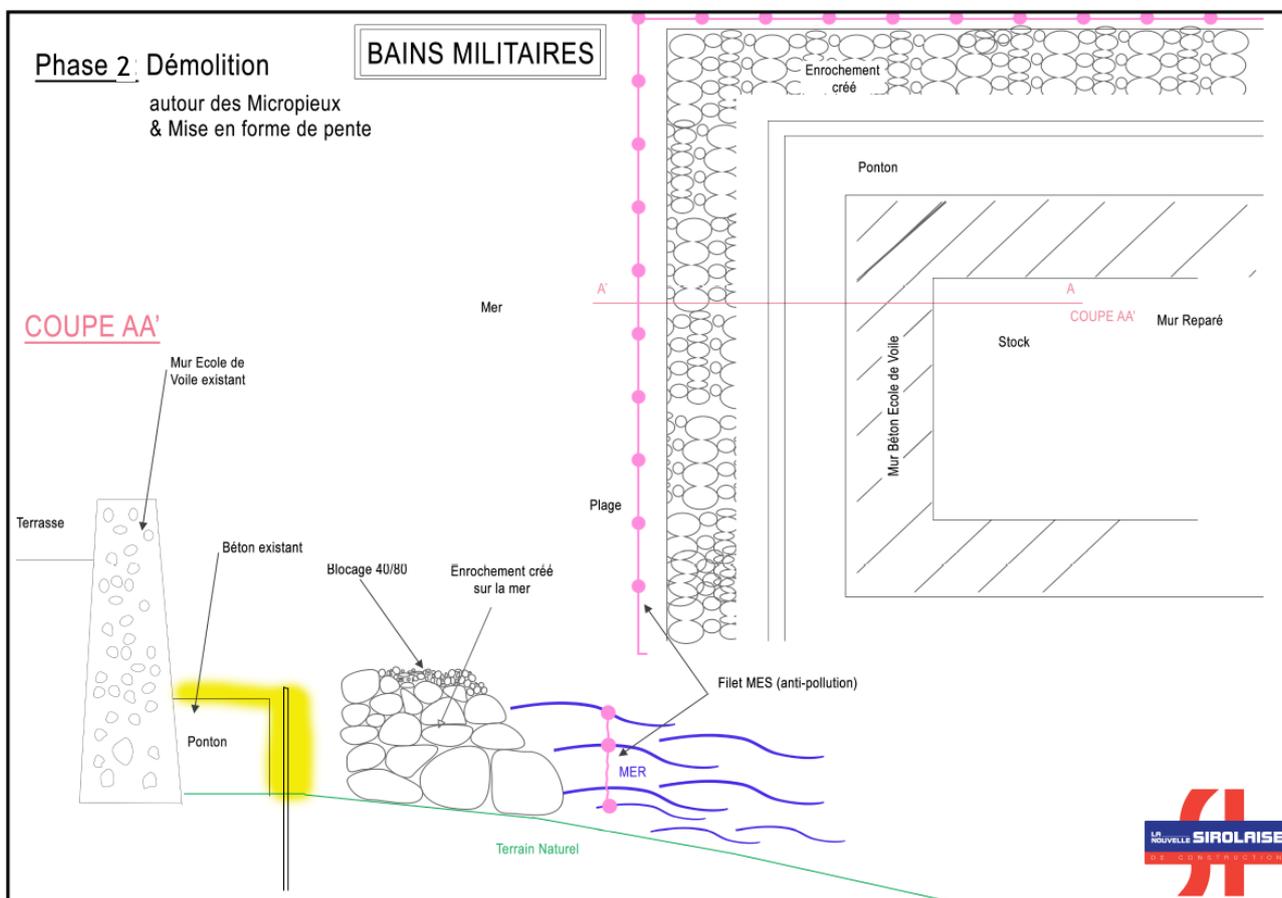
Plan de coupe des travaux de phase2 - étape 2 (source : La Sirolaise)
